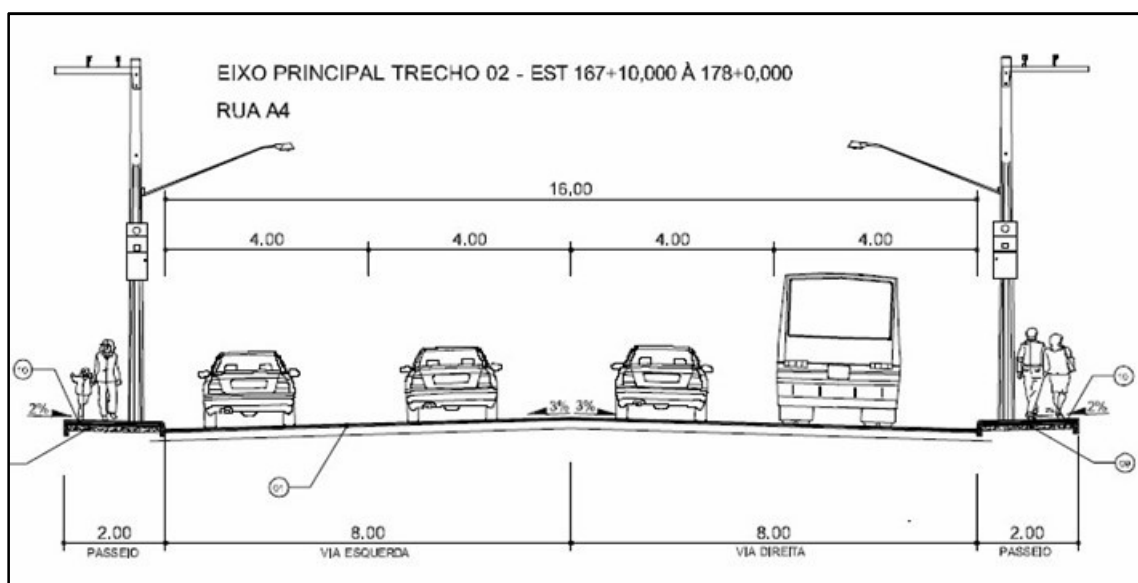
Via Perimetral: perfil transversal trechos sobre via existente
